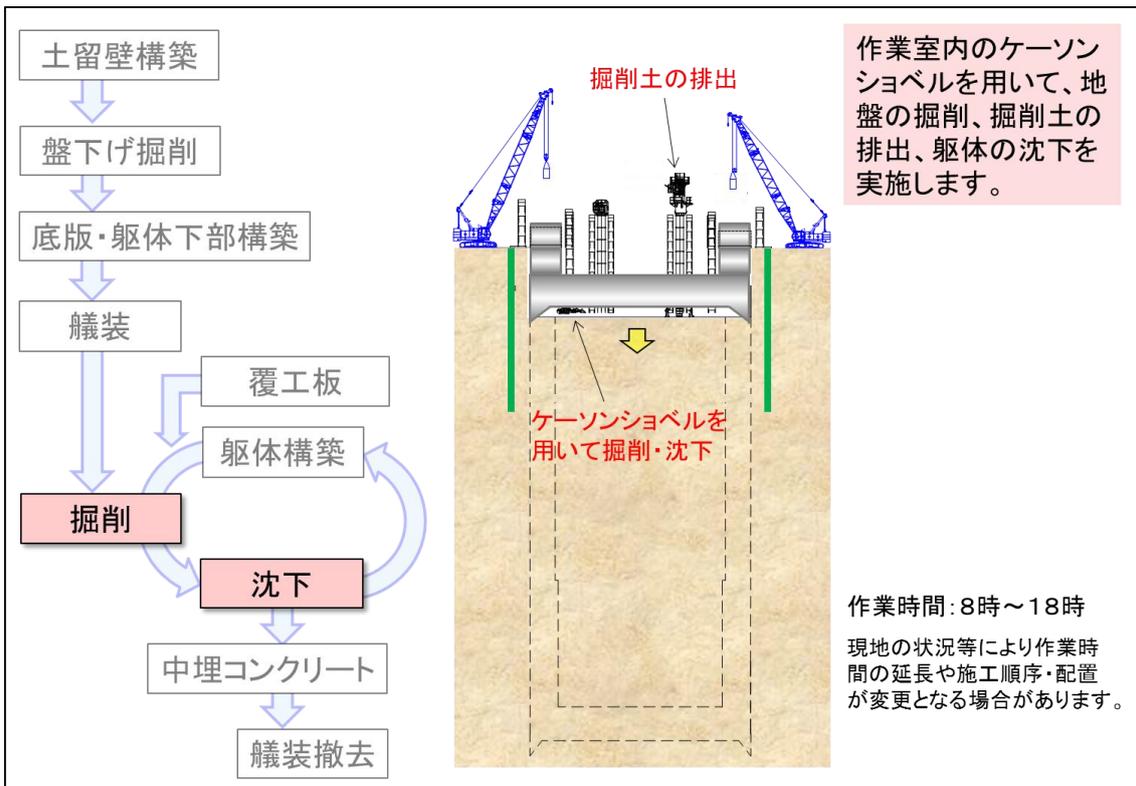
(8) ニューマチックケーソン工（掘削・沈下）の施工手順
